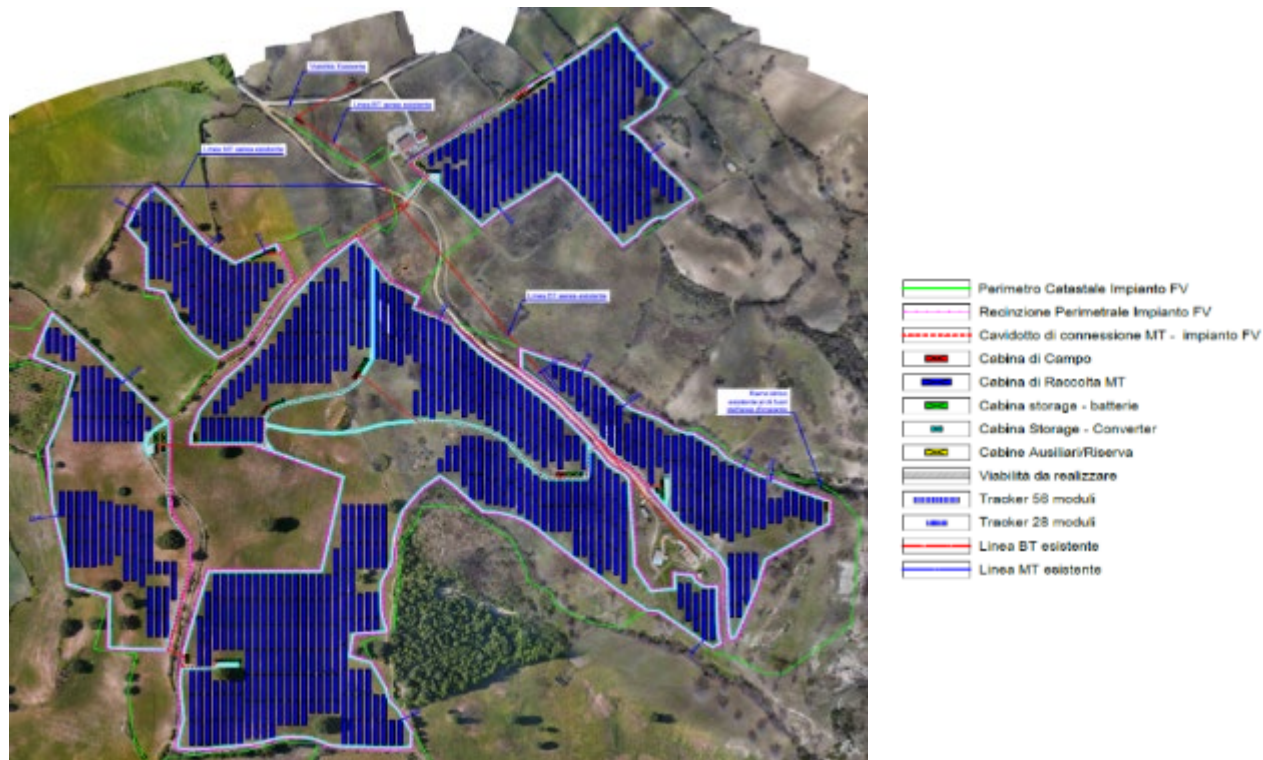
Stralcio planimetria impianto<sup>27</sup> con inquadramento territoriale da ortofoto
